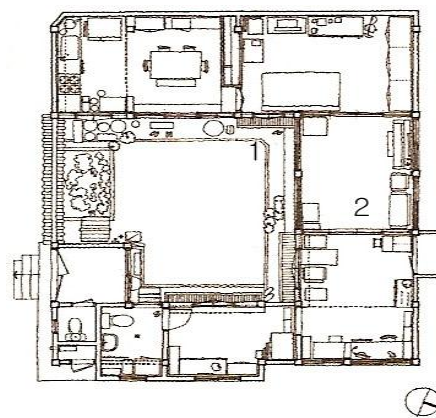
Grundriss einer städtischen traditionellen Wohnung
